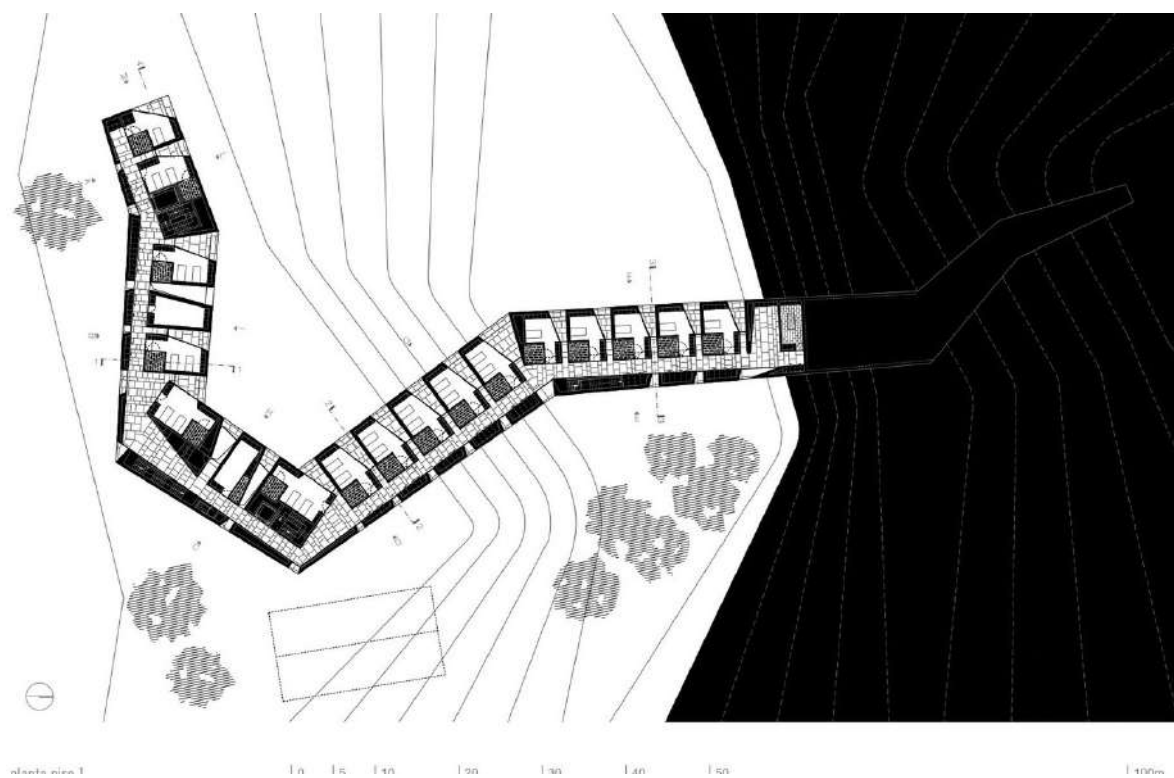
Plano distribución Planta 1. Fuente: www.archidaily.com
